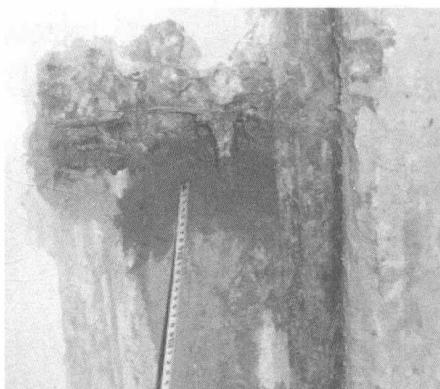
结构混凝土内部钢筋锈蚀 (一)
